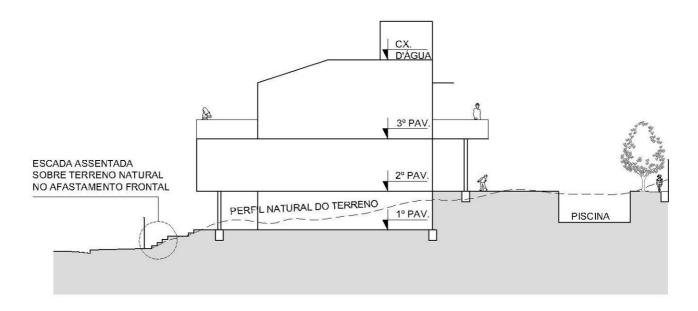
Elemento construtivo no afastamento frontal terreno em aclive: escada
